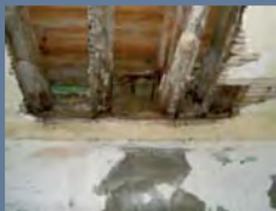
Degradação de vigamento de pavimento em madeira - apodrecimento por ataque xilófago, redução de secção resistente.
